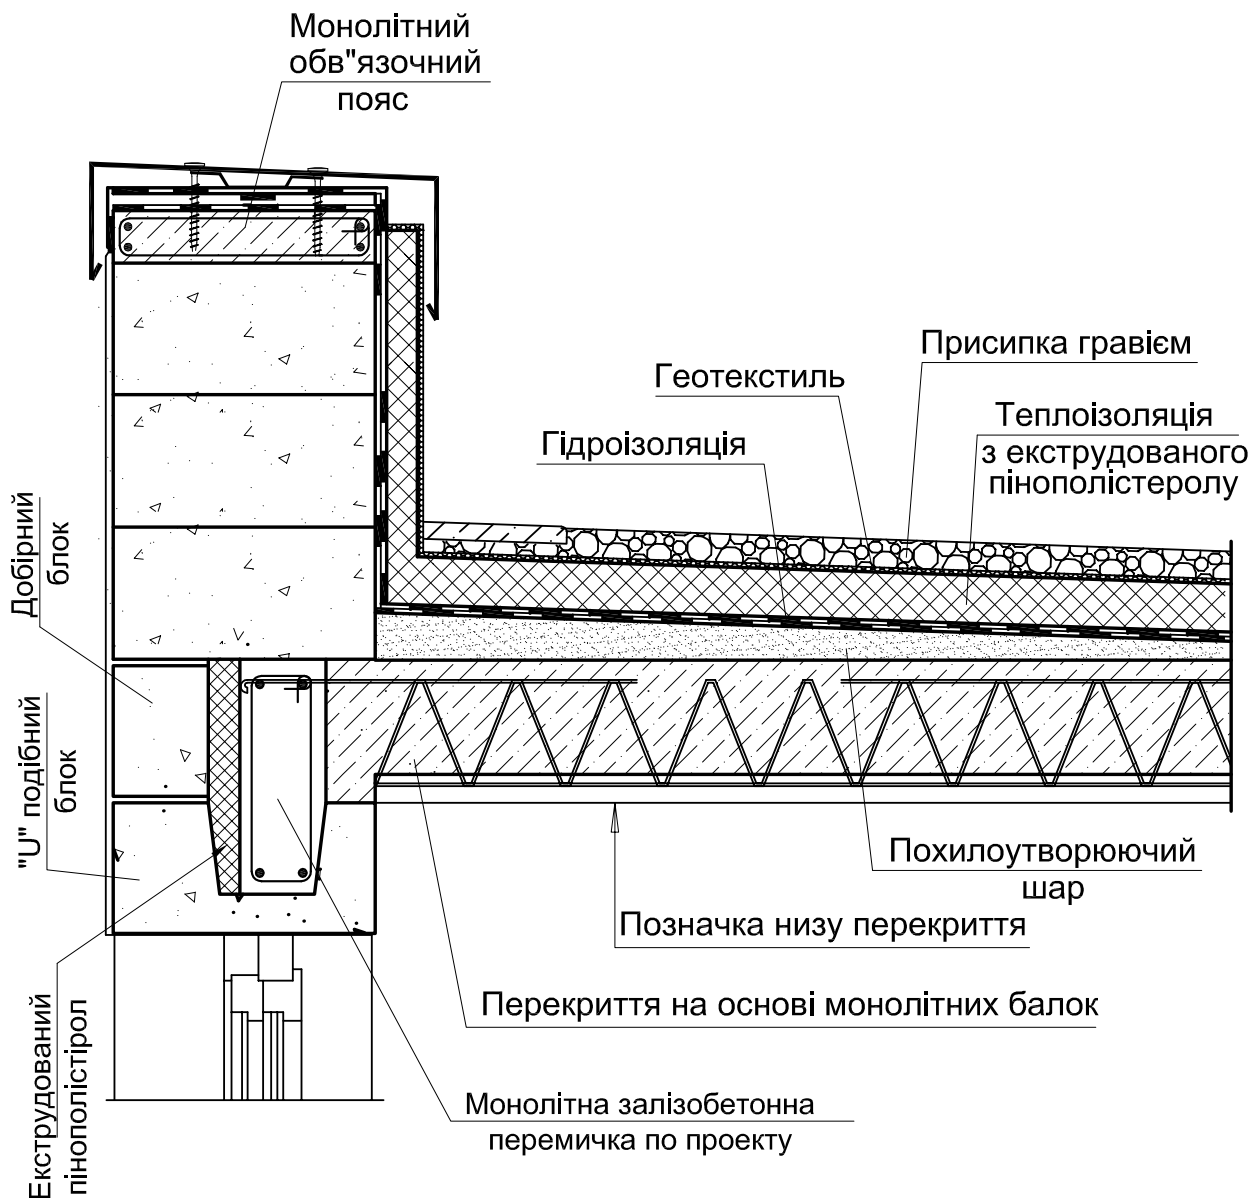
Конструювання утепленого плоского даху над збірно-монолітним дрібноштучним перекриттям даху. Проекція вздовж несучих балок
